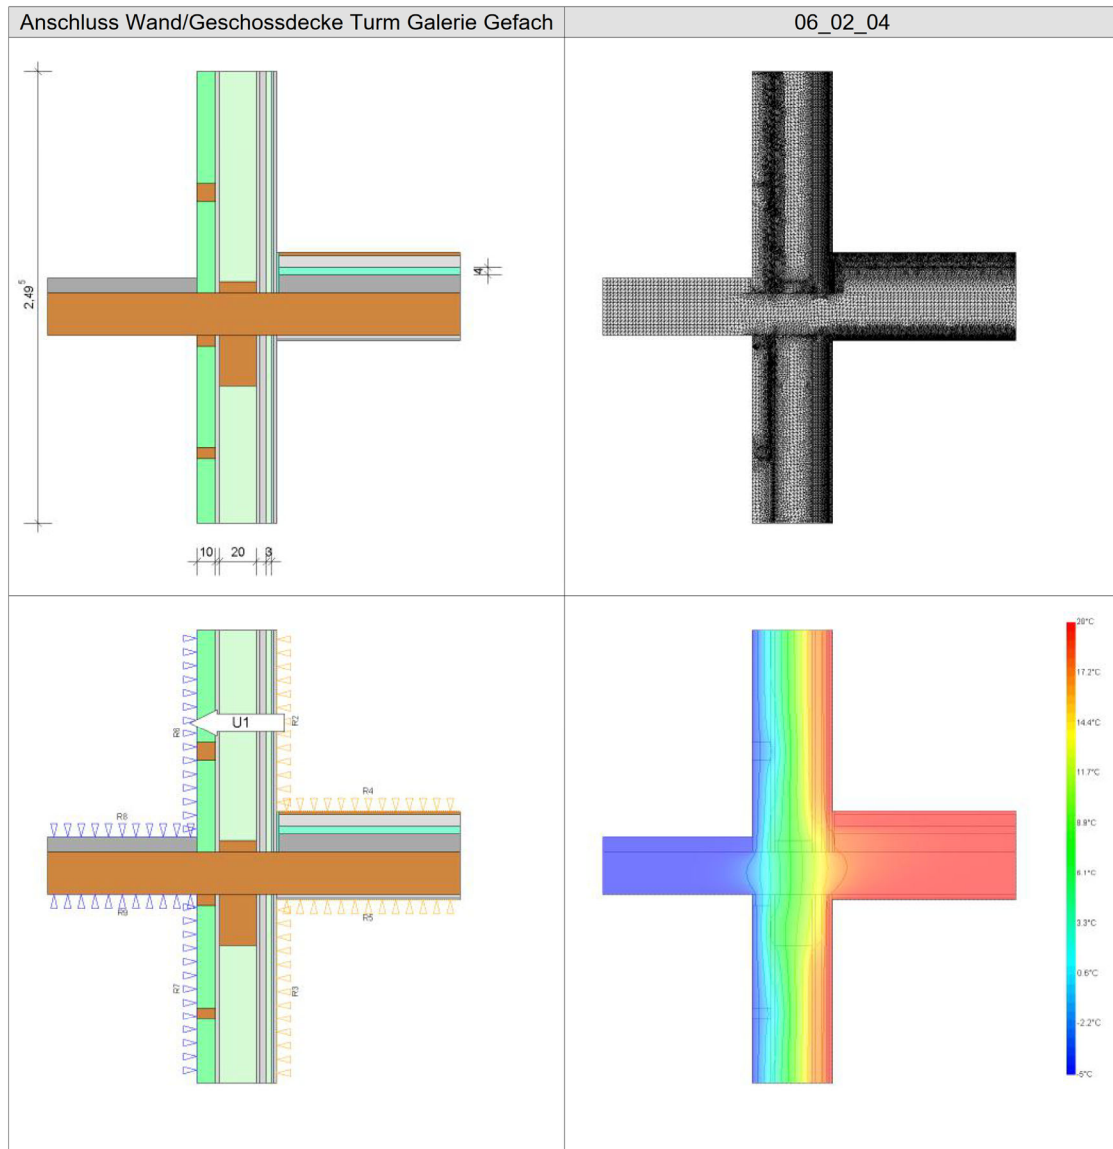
Ergebnisübersicht Wärmebrücke Anschluss Wand/Geschossdecke Turm (KuK)
